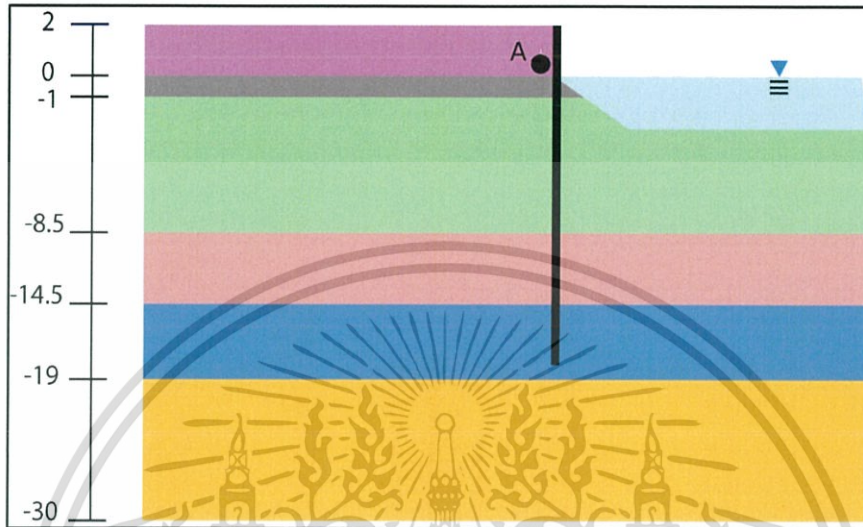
ระบบ Retaining wall ลึก 16 เมตร
